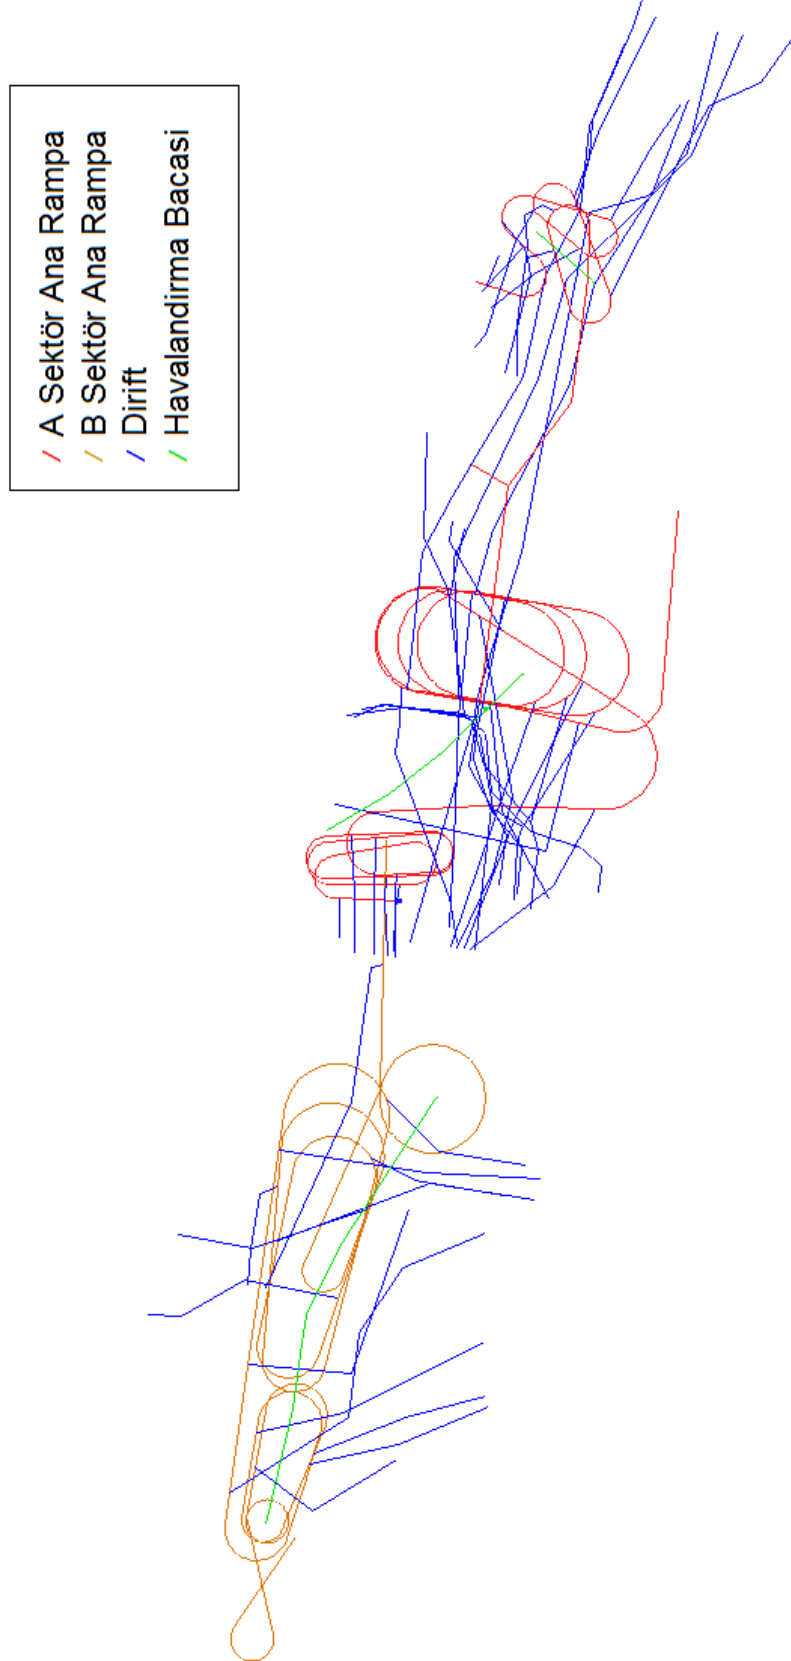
2. Ana rampa ve havalandırma güneyden bakış planı
